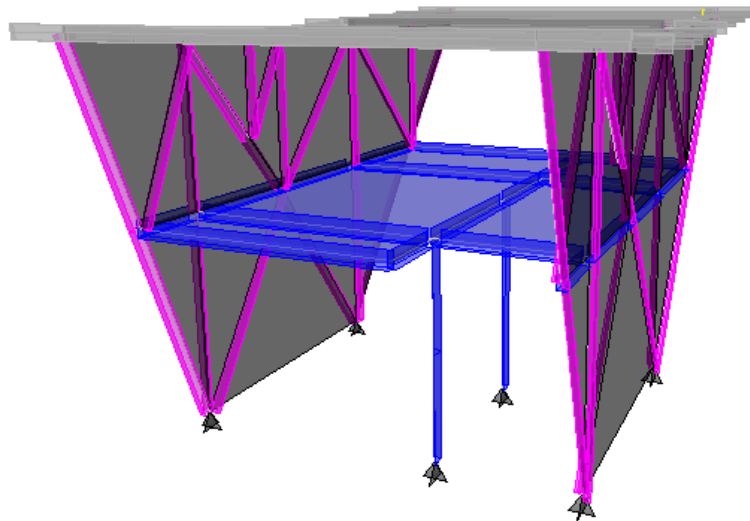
Vista 3D de elementos estructurales de vivienda de guadua laminada
